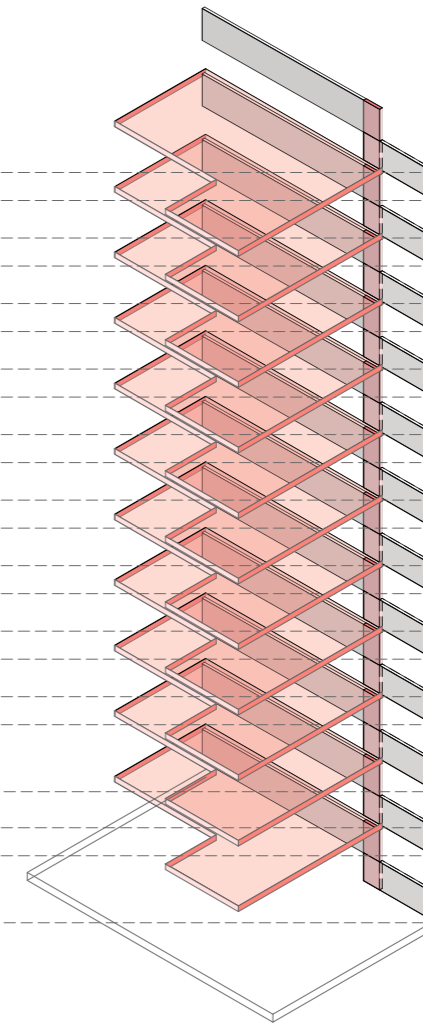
ESQUEMA AXONOMÉTRICA SISTEMA VIGA / LOSA / VIGA
